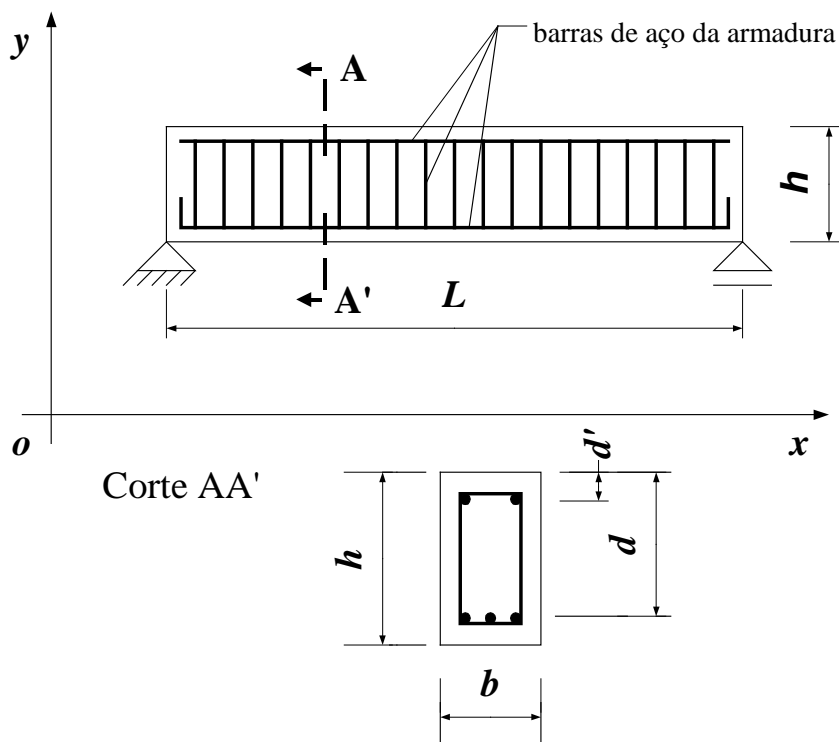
Características geométricas de uma estrutura plana de concreto armado
